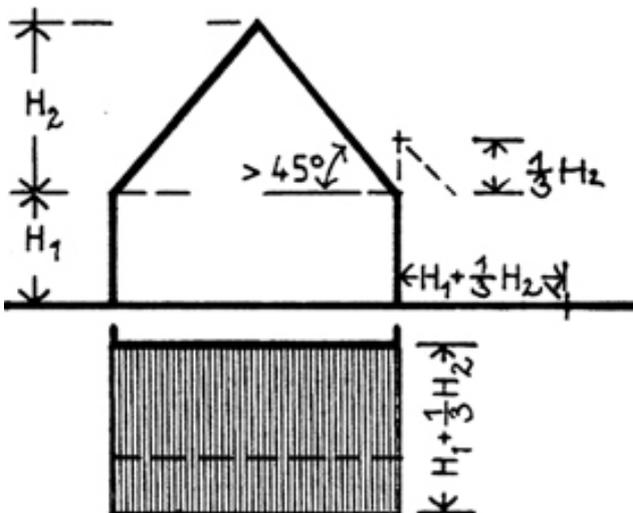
Anrechnung der Dachhöhe und Giebelflächenhöhe auf die Abstandsfläche je nach Dachneigung, Abs. 4 Satz 3 und 4 (Text Ziffer 10)
